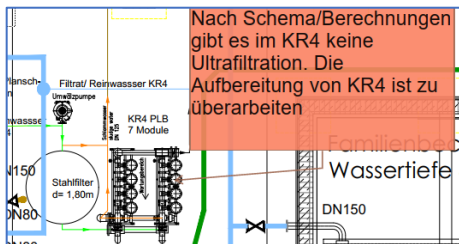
2.4.33 2021-10-22 905 472 Wassertechnik Grundriss E-2 Aufstellplan
